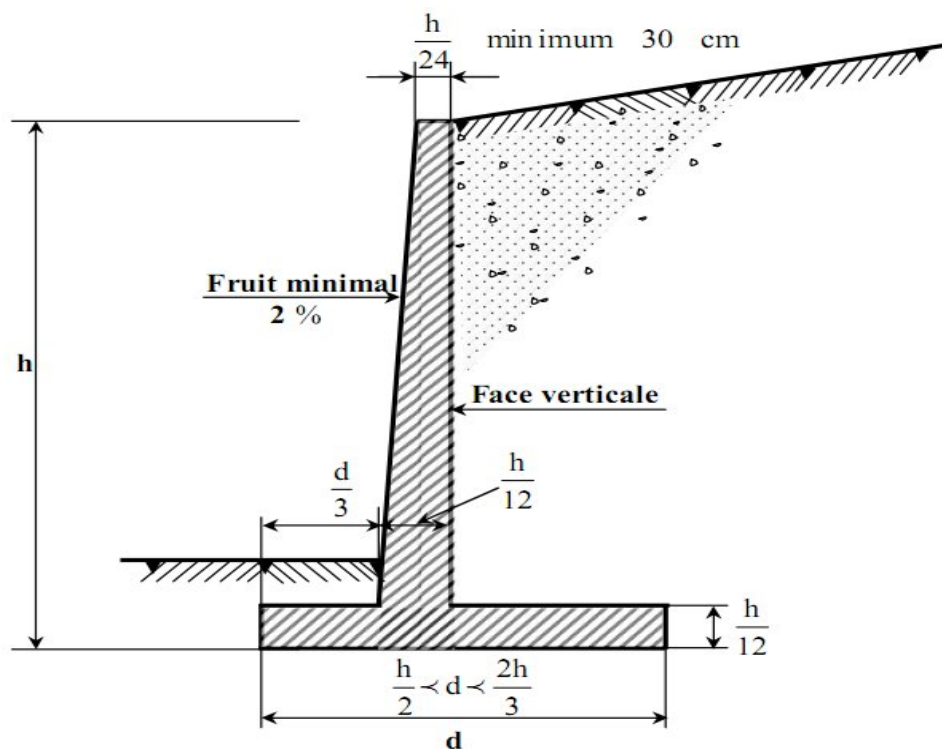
Dimensions usuelles d'un mur voile [15].
